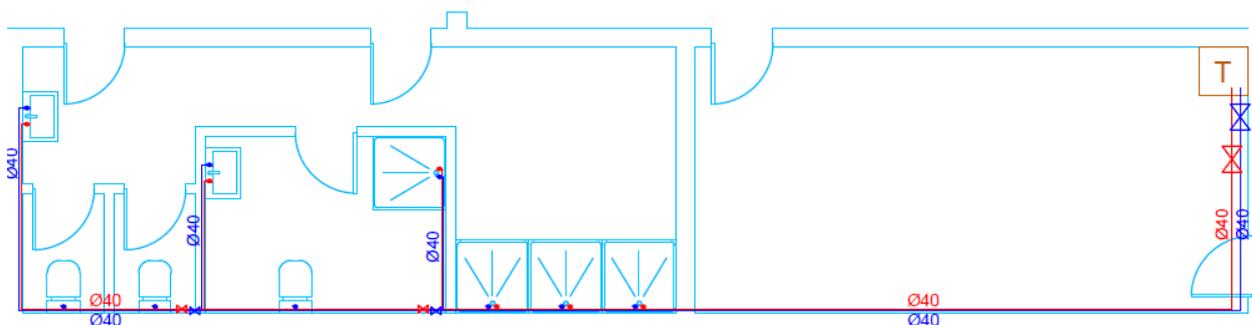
Detalle de la fontanería del baño. Elaboración propia
